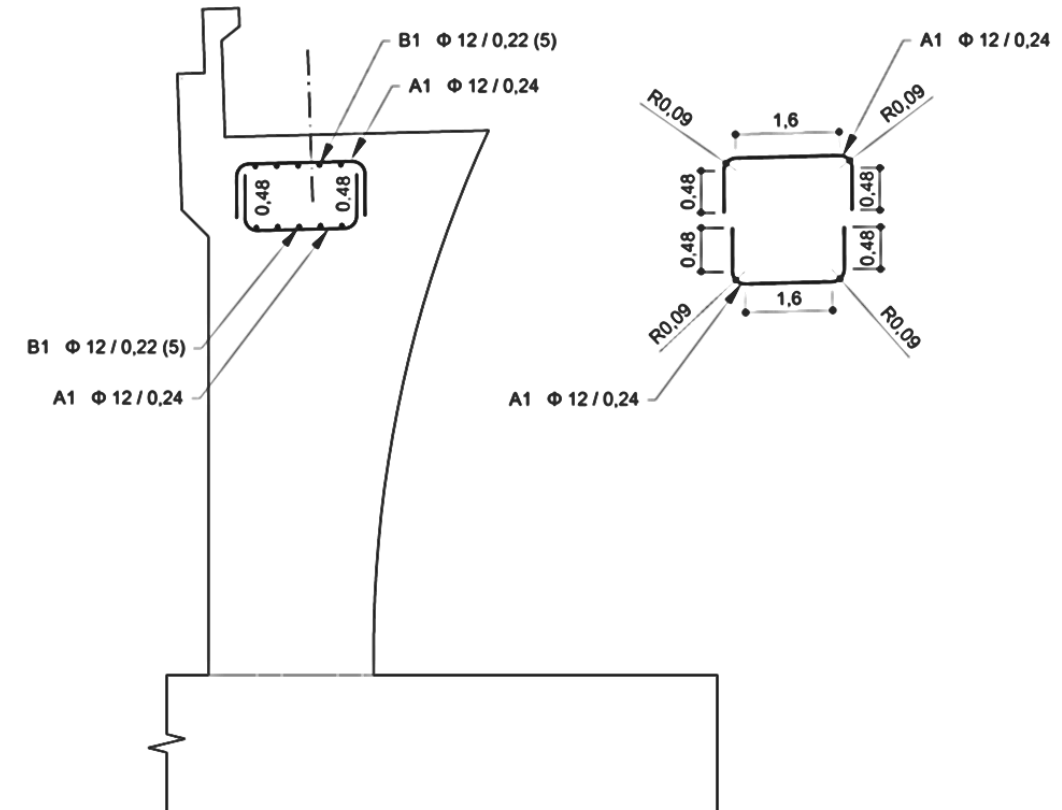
ARMADO Y DESPIECE DEL ESTRIBO POR CARGAS CONCENTRADAS.
